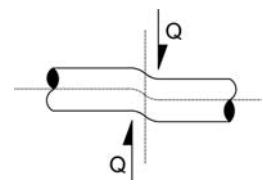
Reine Querkraftbeanspruchung der Dübelbewehrung
